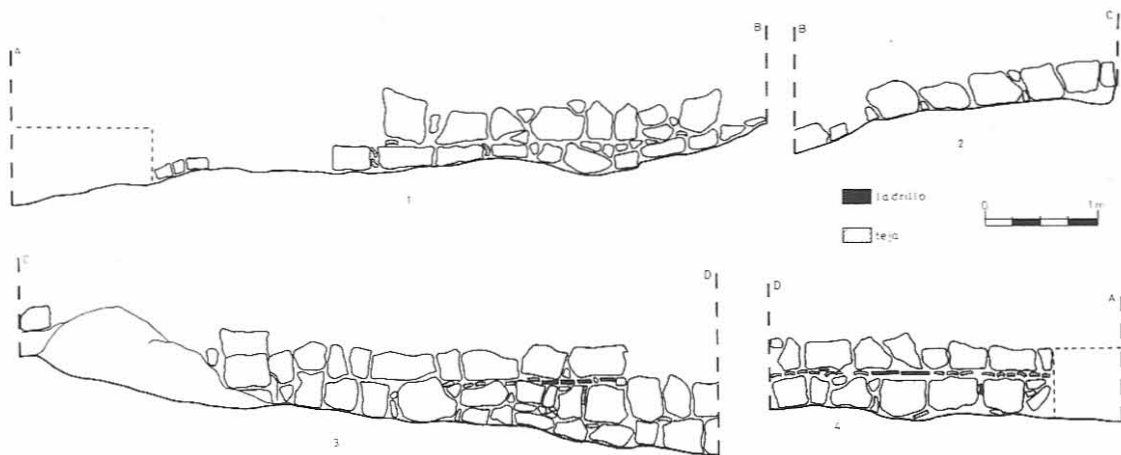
Alzados de los muros, vistos desde el interior, del sector 6. 1. Muro oeste. 2. Muro norte. 3. Muro este. 4. Muro sur.
